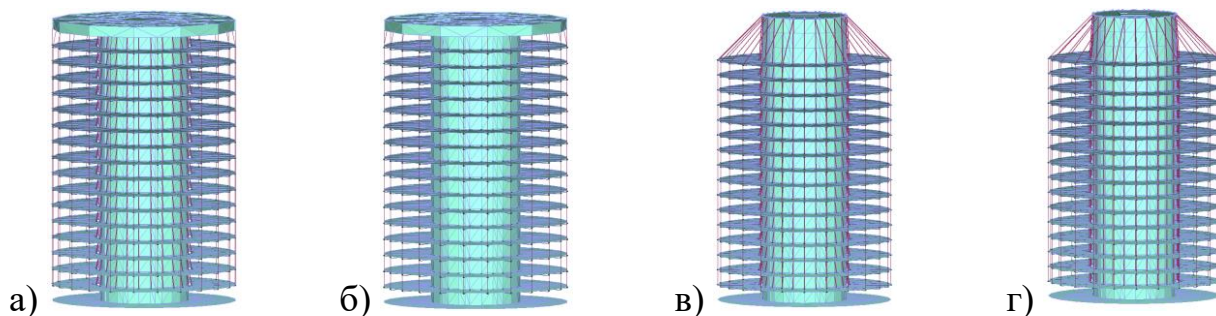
Расчётная модель здания ствольно-подвесного типа с: а) первой расчётной схемой; б) второй расчётной схемой; в) третьей расчётной схемой; г) четвёртой расчётной схемой
